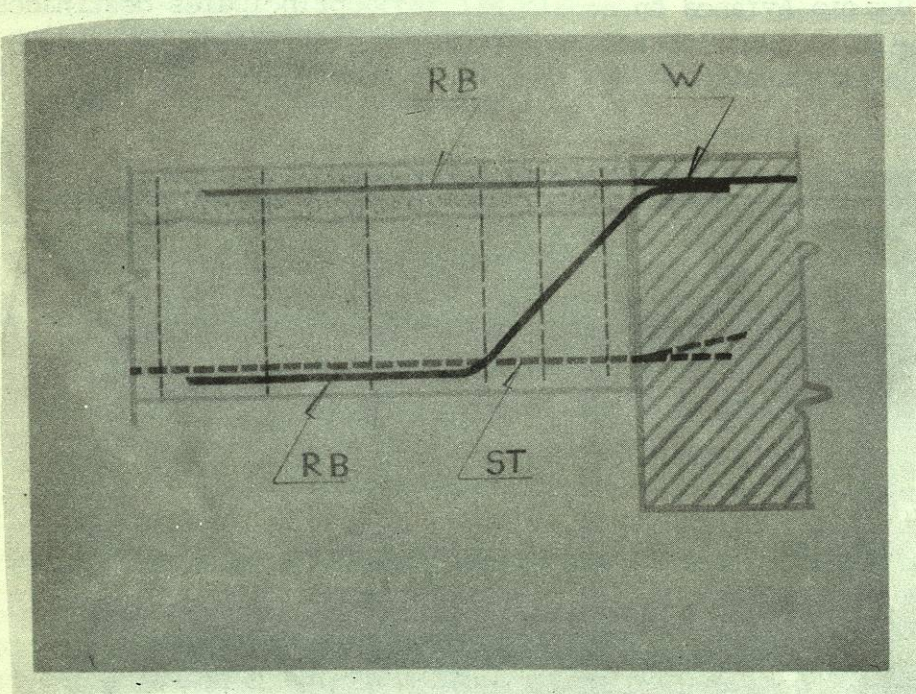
Empotramiento de las viguetas prefabricadas en las vigas postensionadas.
